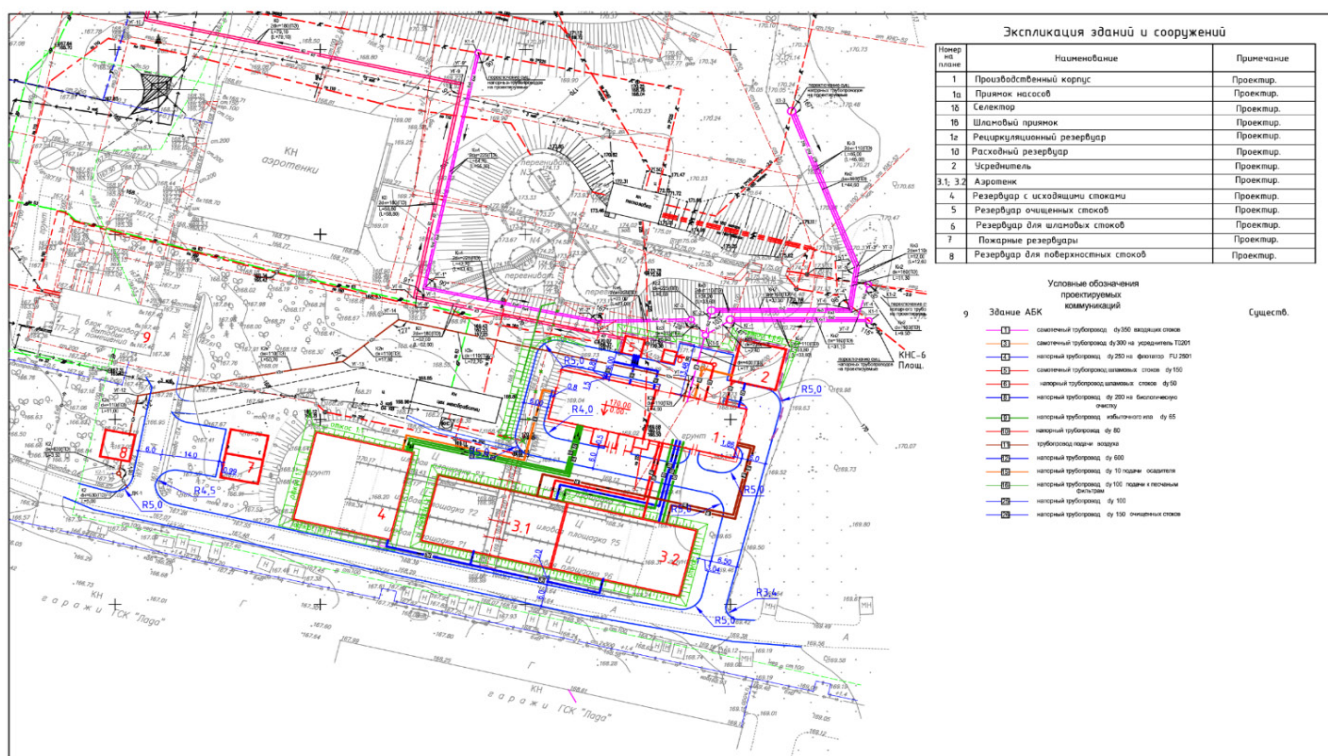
Схема расположения зданий, сооружений и трубопроводов на площадке КОС ООО «УПФ»
